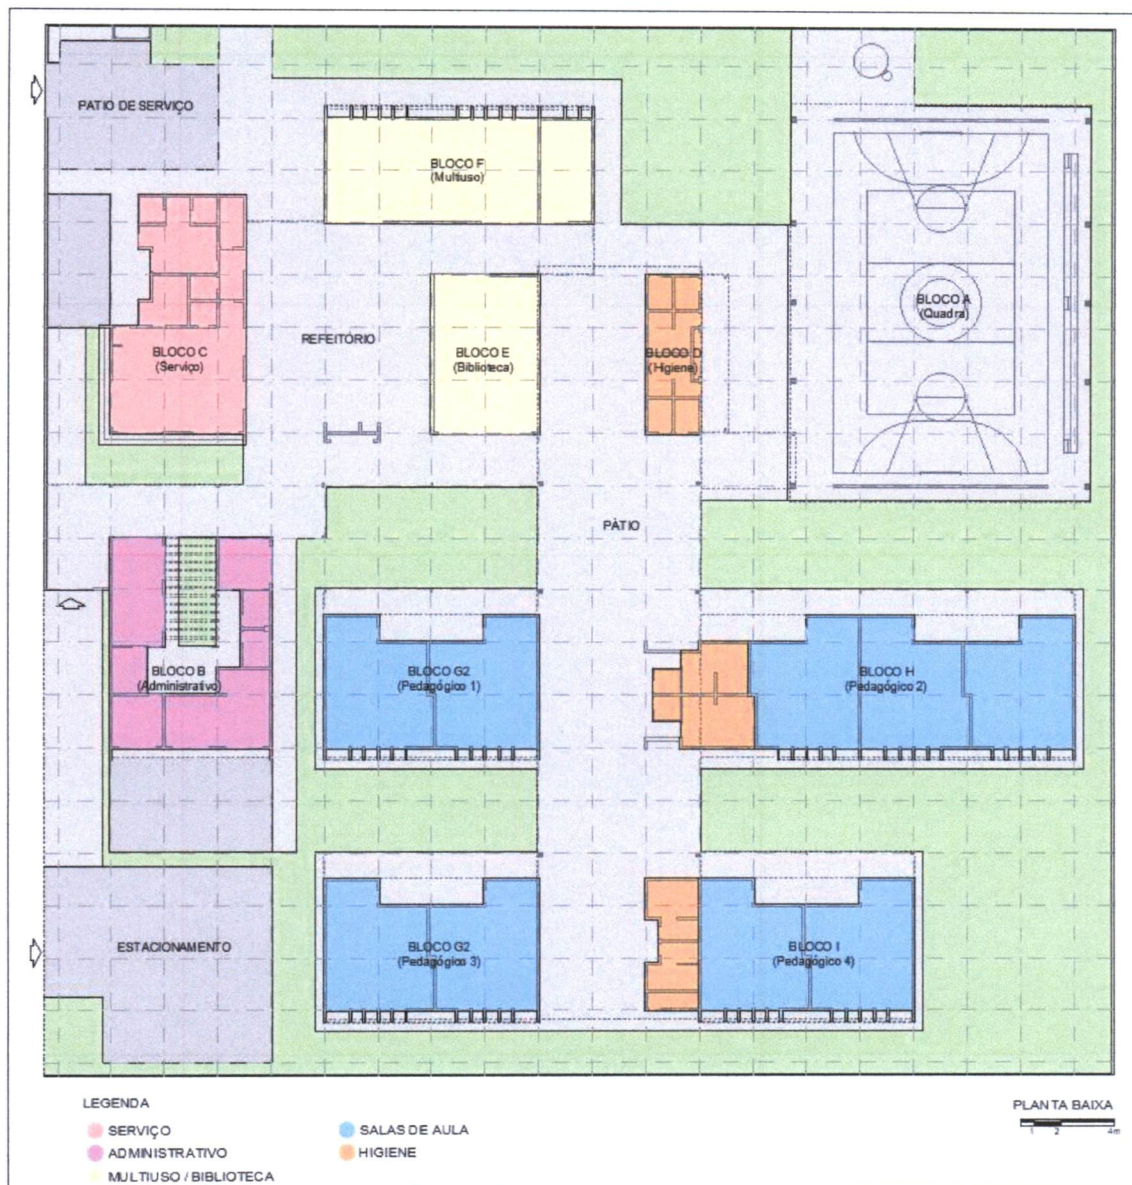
planta baixa de implantação dos blocos – Escola 9 Salas - Térreo
